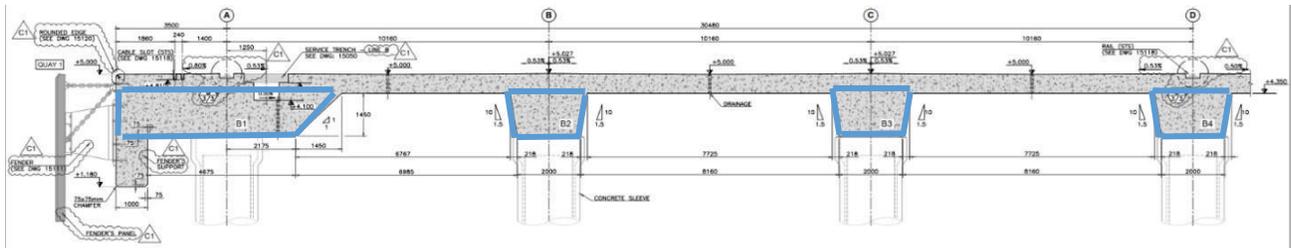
Sección transversal de vigas Q3/Q4. Fuente: Cotema
